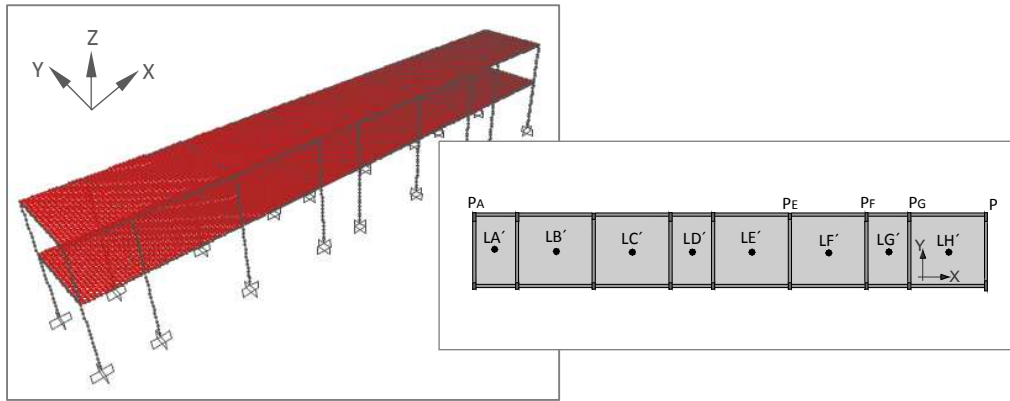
Planta da estrutura global tipo “C” e respetivo modelo de elementos finitos
